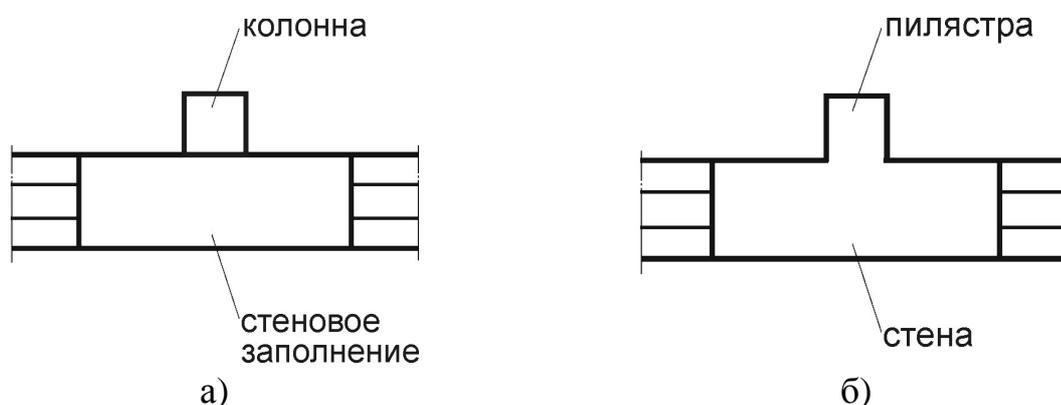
Схемы расположения строительных элементов каркасного (а) и бескаркасного (б) зданий
